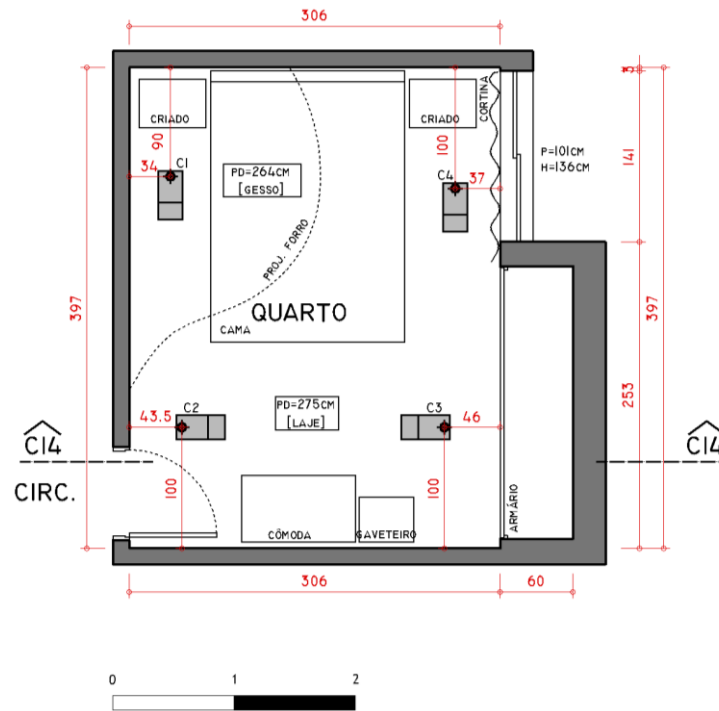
Planta ambiente emissor (pavto. superior) - Ensaio 14
